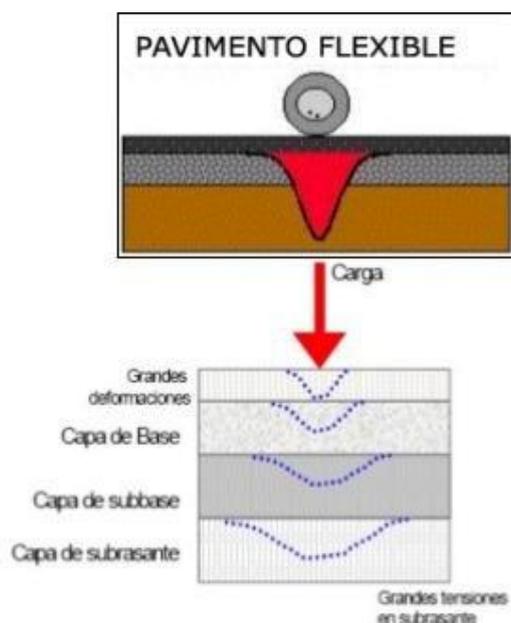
Transmisión de cargas verticales a un pavimento flexible.
